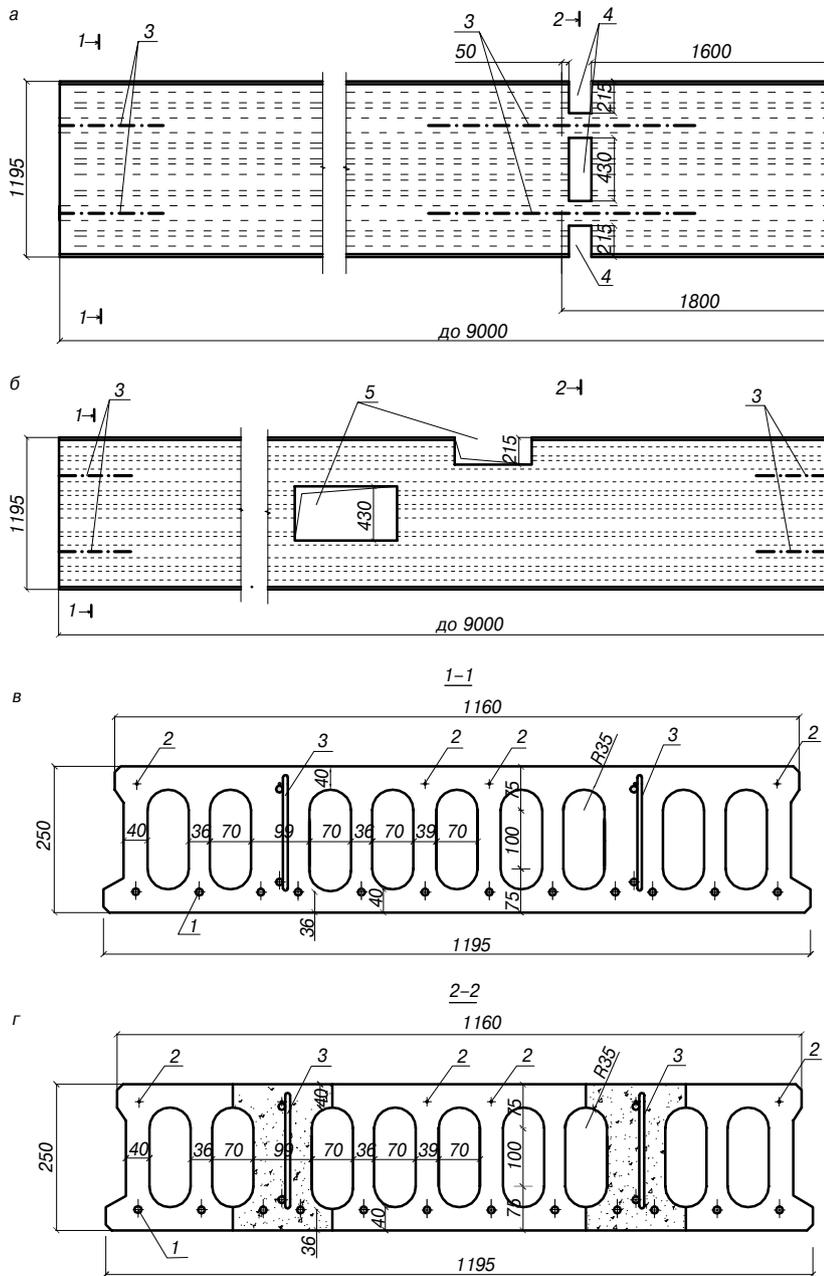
Многопустотная плита перекрытия безопалубочного формирования с усиленными ребрами: а – плита с вырезами для терморазъемов, вид сверху (1800 мм балконная консоль); б – плита перекрытия с вырезами для прокладки инженерного оборудования; в – сечение плиты по опорной зоне; г – сечение плиты в месте расположения терморазъемов; 1 – предварительно напряженная рабочая арматура; 2 – верхняя конструктивная арматура; 3 – арматурный каркас; 4 – вырез в плите под терморазъем; 5 – вырезы под инженерные коммуникации
